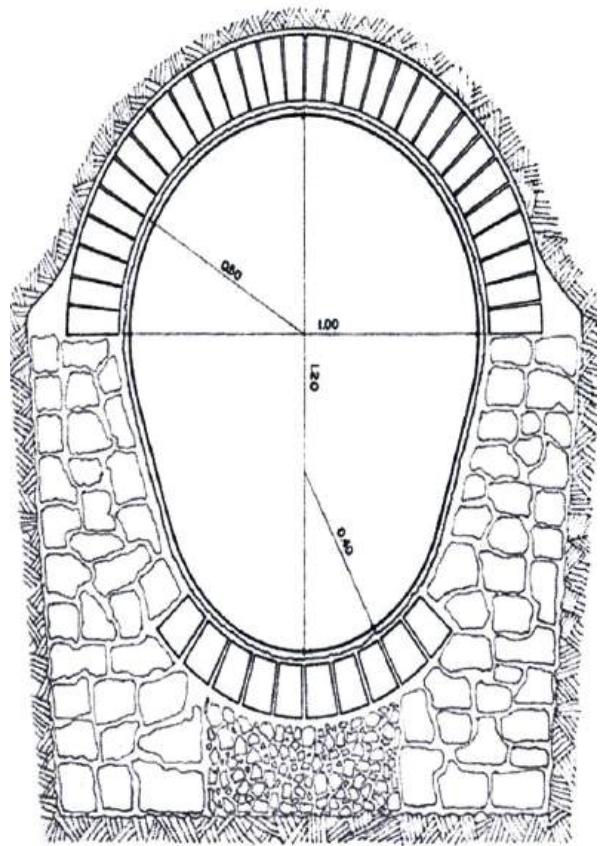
Corte transversal de un caño maestro con piso cóncavo (Memoria).
